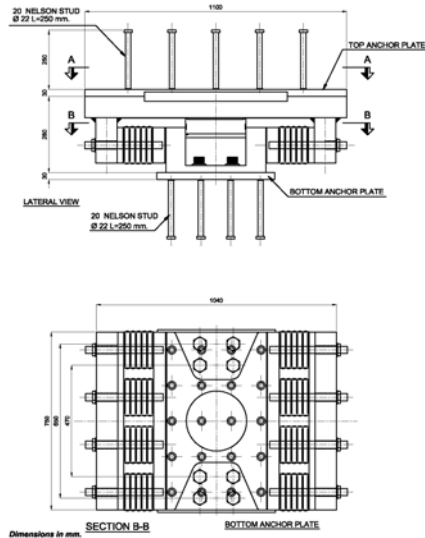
Vista de un dispositivo de apoyo con neoprene precomprimido
